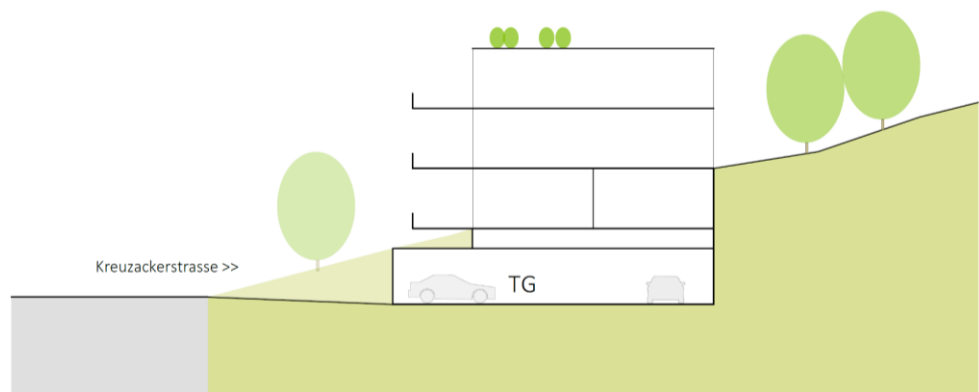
Erschliessung der Tiefgarage mit ebenerdiger Zufahrt ab der Kreuzackerstrasse
